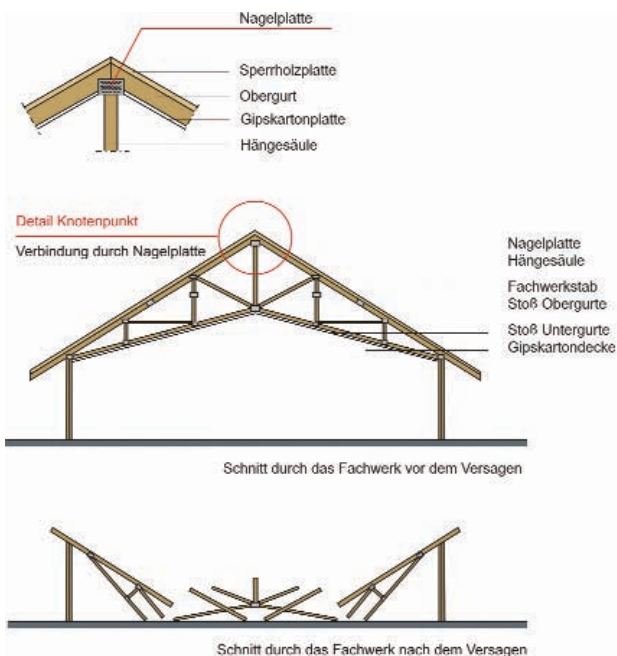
Schnitt durch das Fachwerk vor und nach dem Versagen nach [26]
